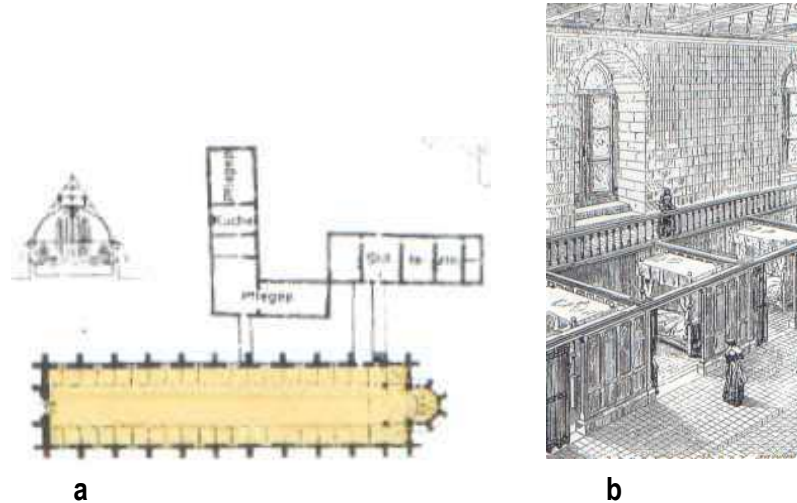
Planta baixa e corte (a) e vista interna (b) do Hospital Tonnerre, França, 1293
